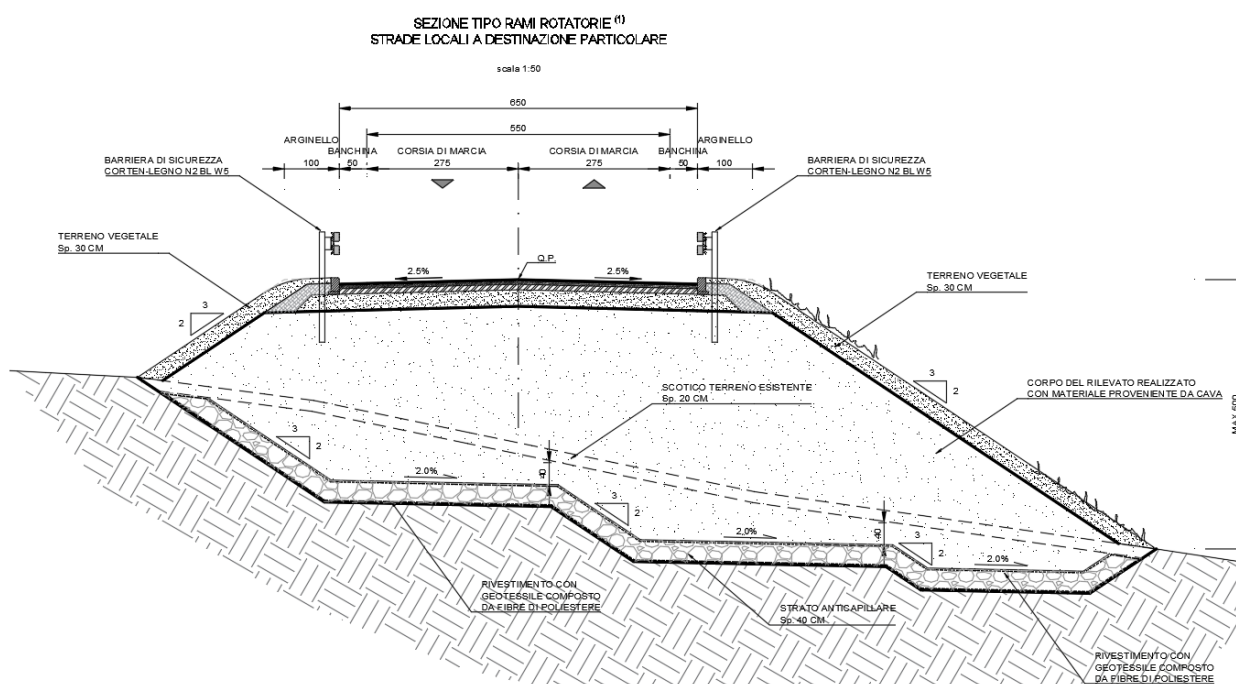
Sezione tipo del ramo 2 della rotonda 3
